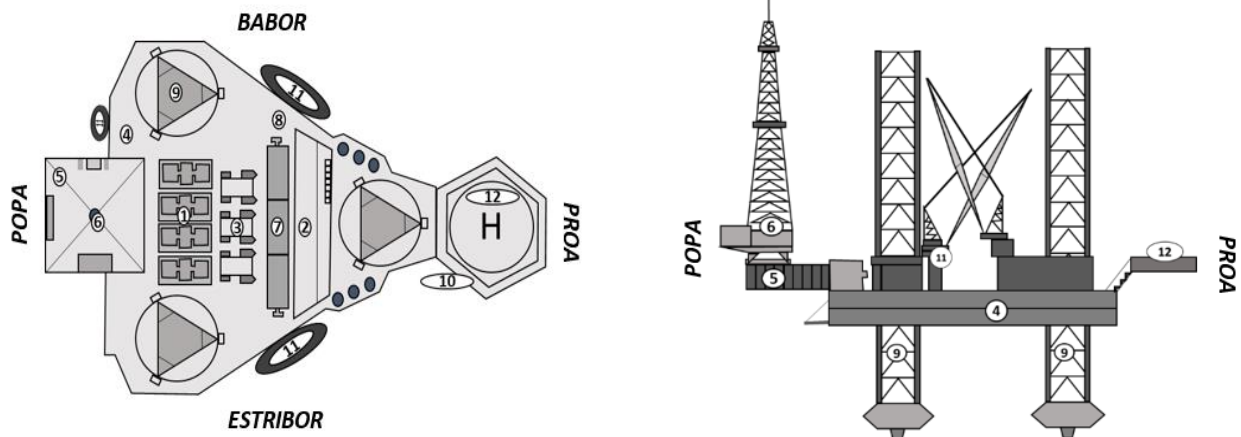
Esquema de Plataforma Auto Elevable (vista de planta y de perfil)
